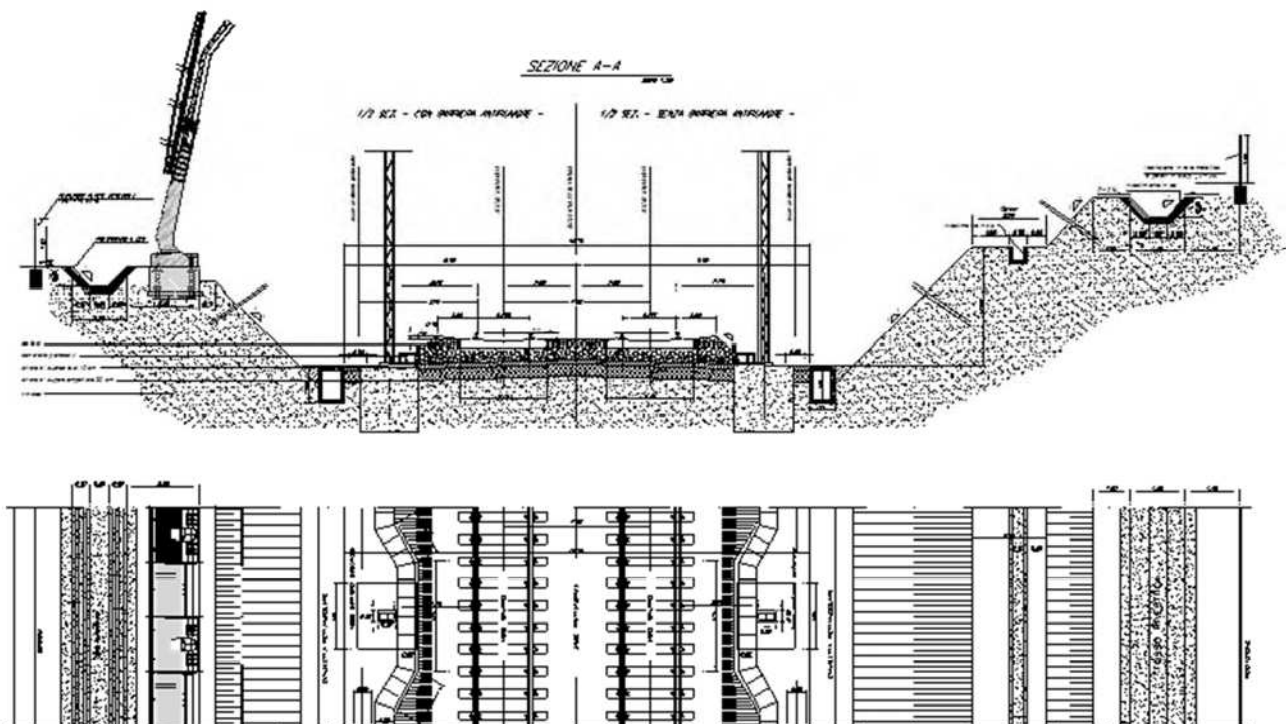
Sezione Tipo doppio binario in Rilevato con Barriere Antirumore
